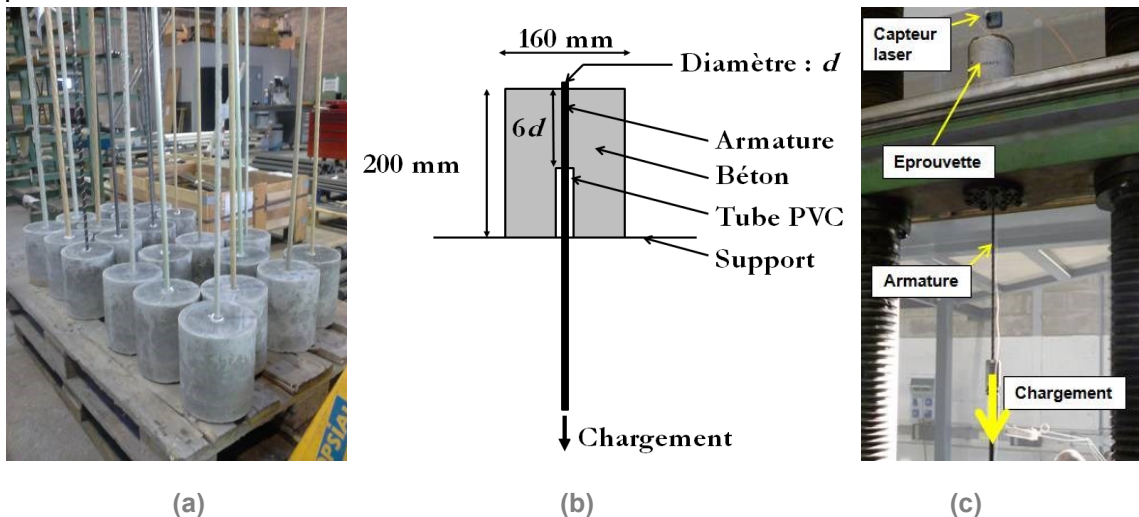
Essai d'arrachement : (a) fabrication des éprouvettes, (b) principe de l'essai, (c) vue du dispositif expérimental
